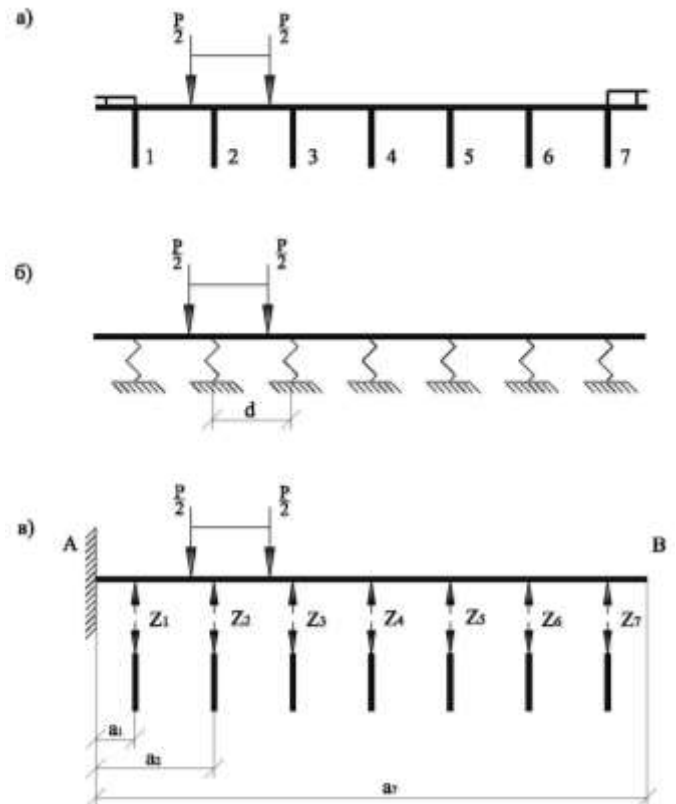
Прольотна будова (а); розрахункова (б) та основна (в) схеми поперечного елемента
